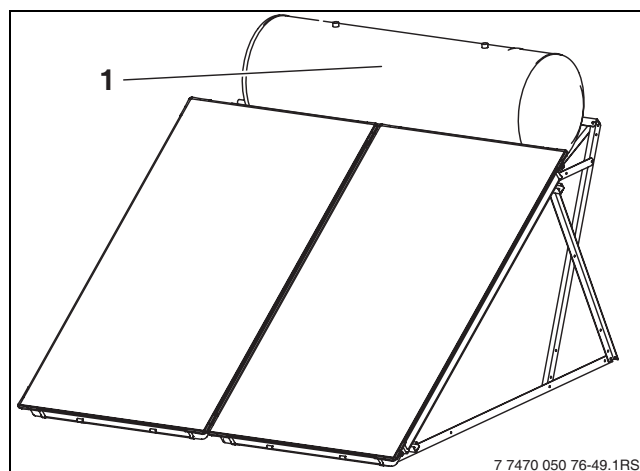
Aperçu du montage sur toit terrasse (ici système 300 l)
